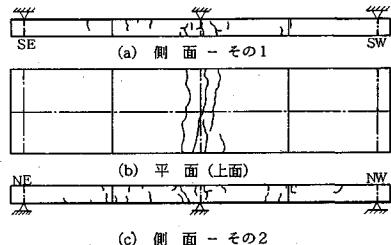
コンクリートのひびわれの発生状況（N=400万回時）
